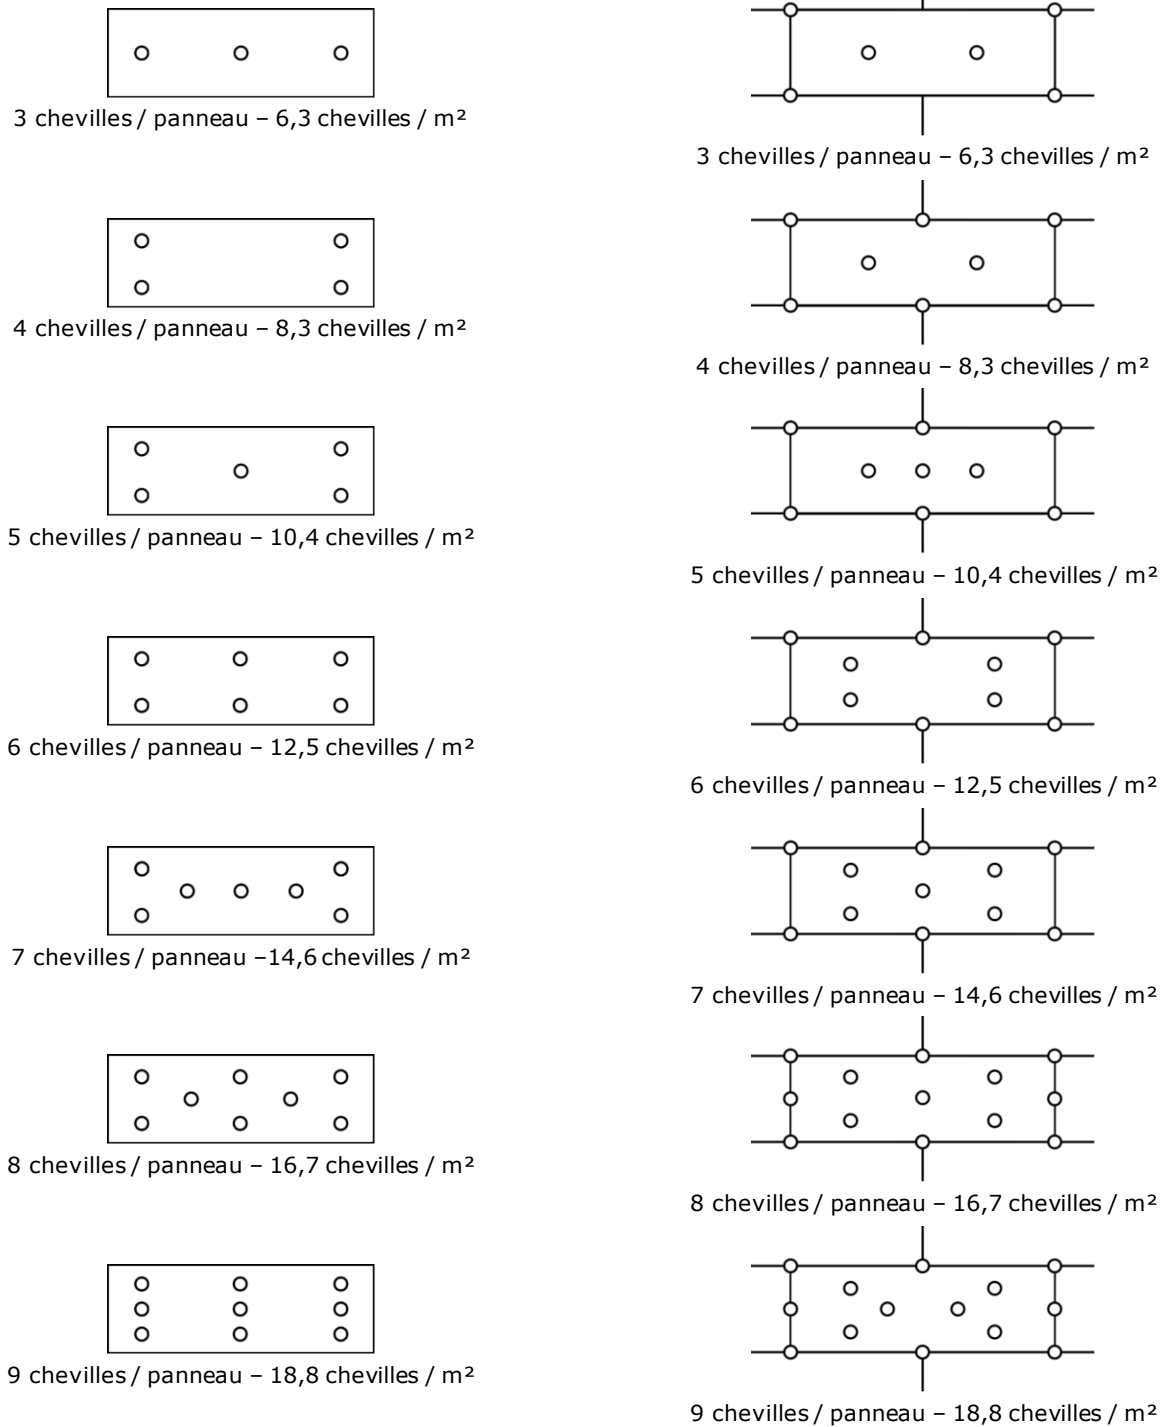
Exemples de plans de chevillage pour des panneaux de 1200 × 400 mm
